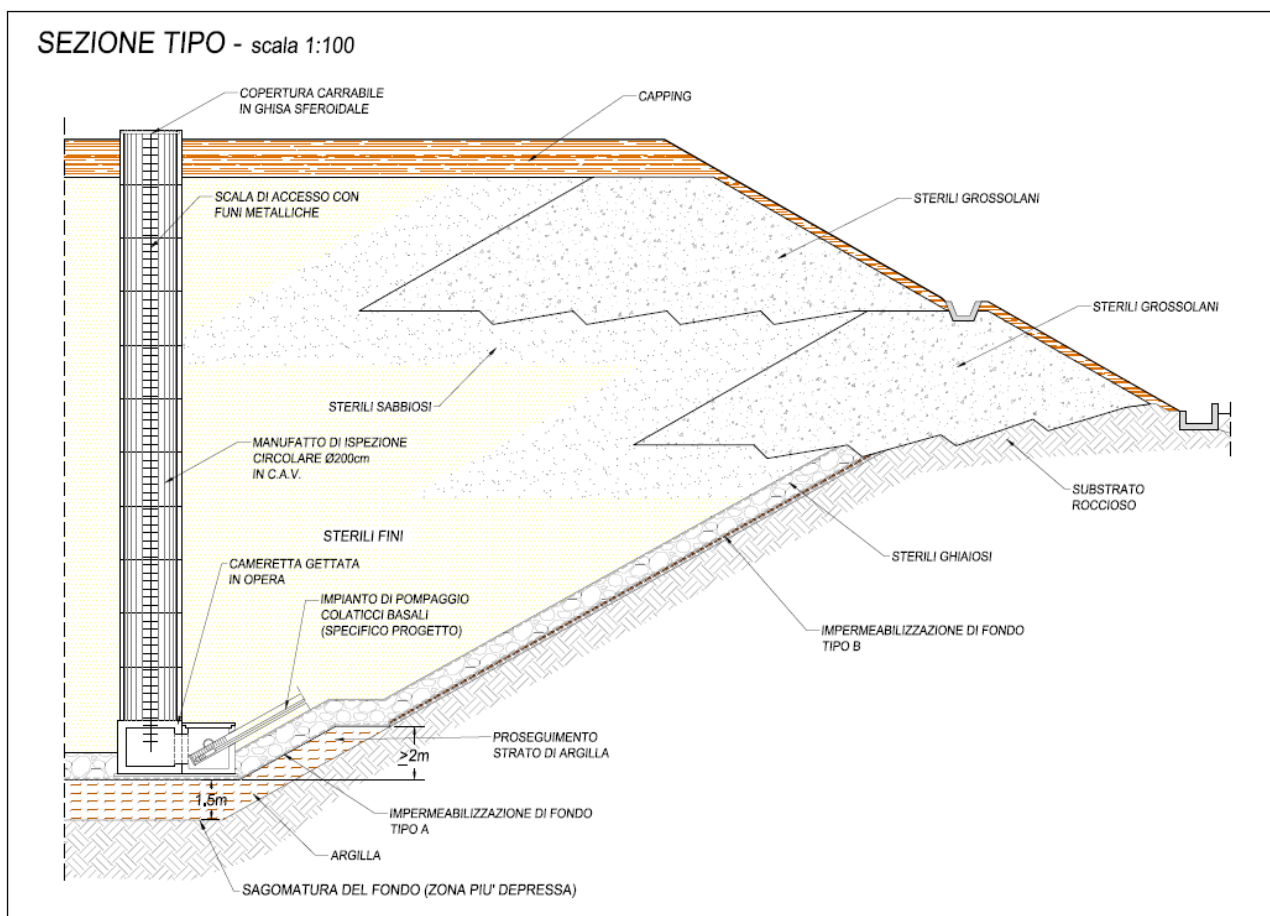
RAPPRESENTAZIONE DEL MANUFATTO DI ISPEZIONE
